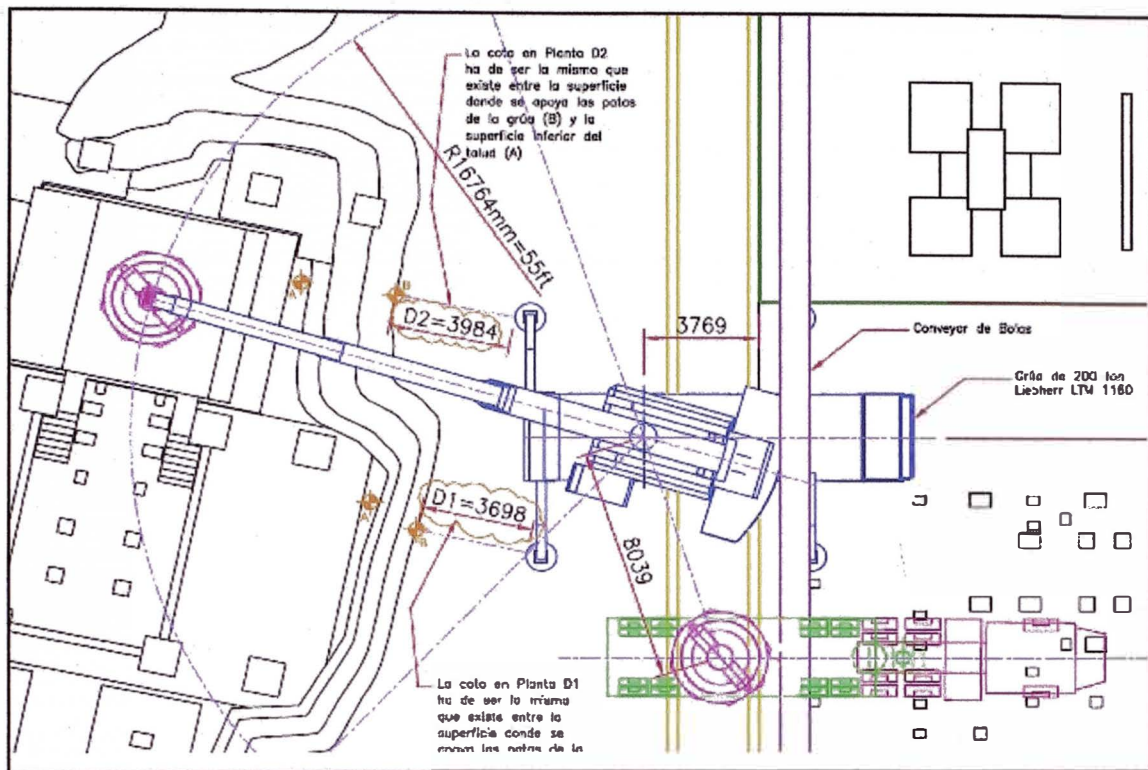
ESQUEMA DE MANIOBRA PLANTA
